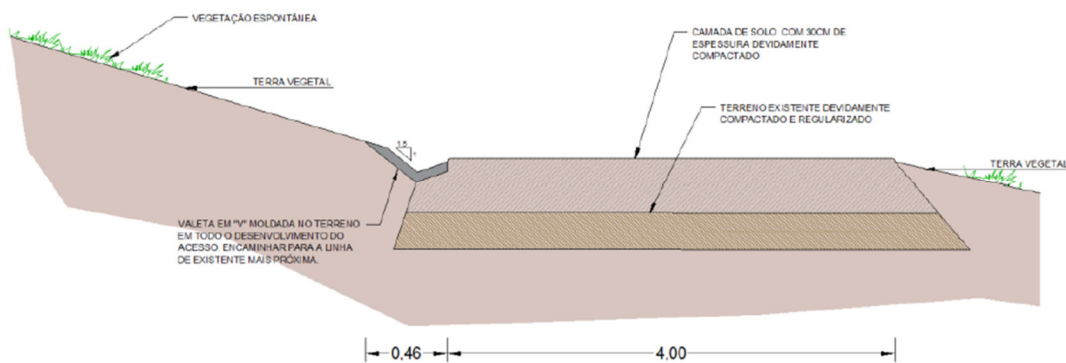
Tipo Perfil transversal del camino exterior (acceso con zanja, a construir/mejorar).
